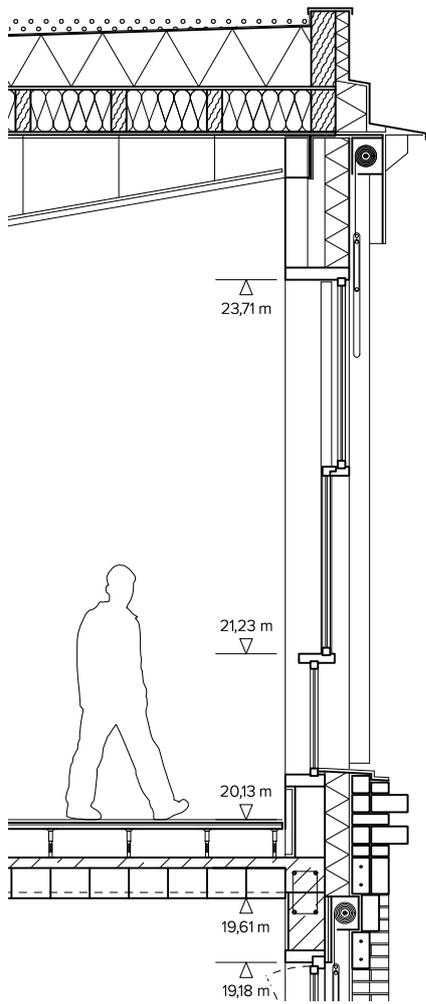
Fassadenschnitt 5. Obergeschoss 1.50 (BM)
